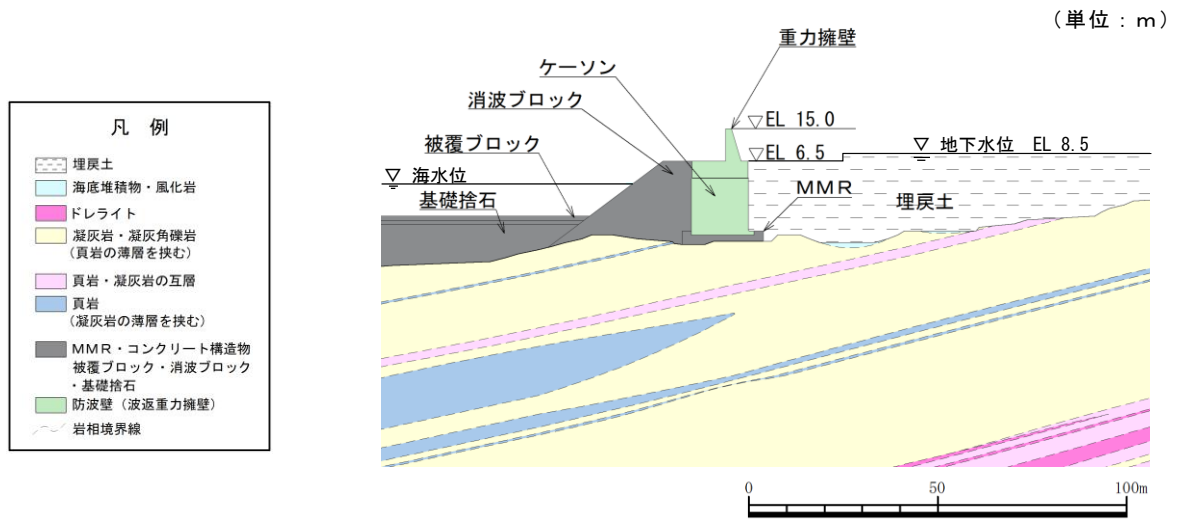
防波壁 (波返重力擁壁) の横断面図 (①-①断面)
